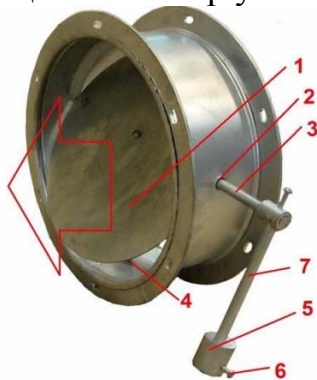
Конструкція круглого зворотнього клапана: 1- заслінка; 2- корпус; 3 – металева вісь; 4 – фіксатор; 5 – вантаж; 6 – гвинт; 7 – допоміжна штанга
